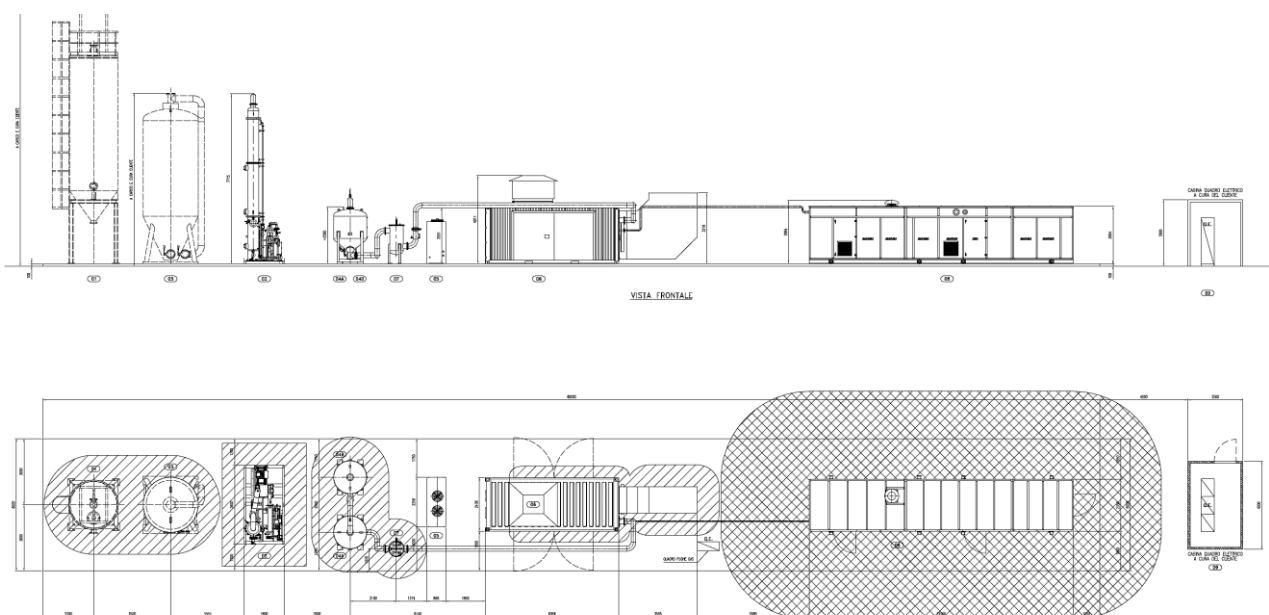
Prospetto e Planimetria del Sistema di Upgrading Schema tipo T.P.I.
